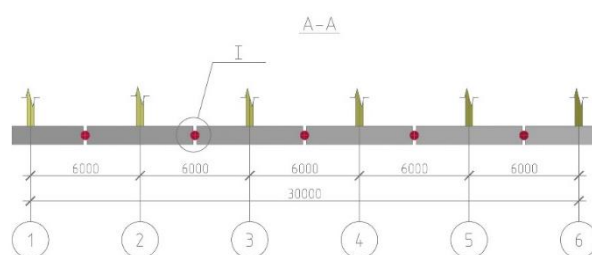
Конструкция фундаментной плиты с регулируемыми усилиями, разрез А-А:
